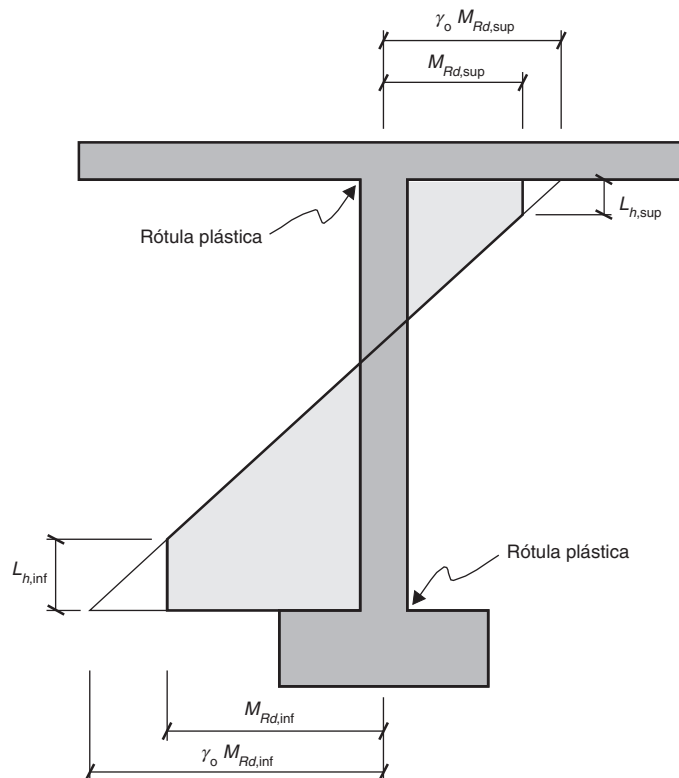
Distribución de momentos por capacidad  $M_C$  para pilas en ménsula y pilas empotradas
